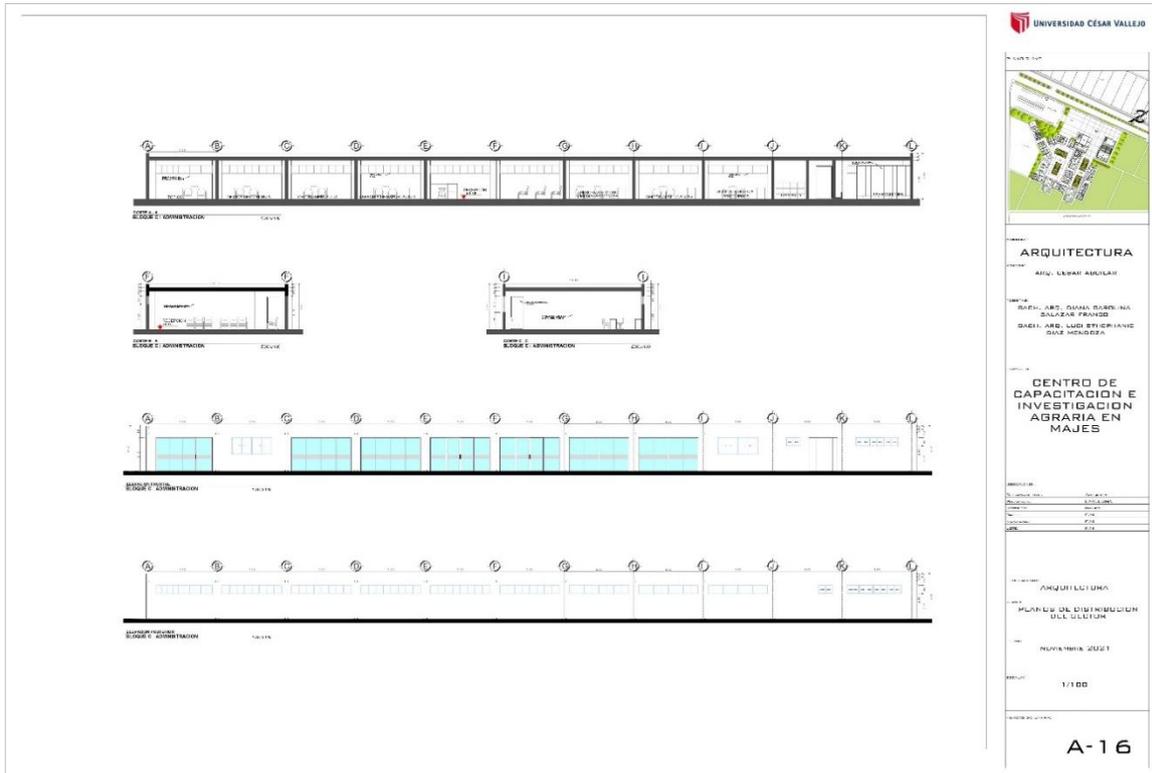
Plano de Cortes y elevaciones por sector: Bloque D
